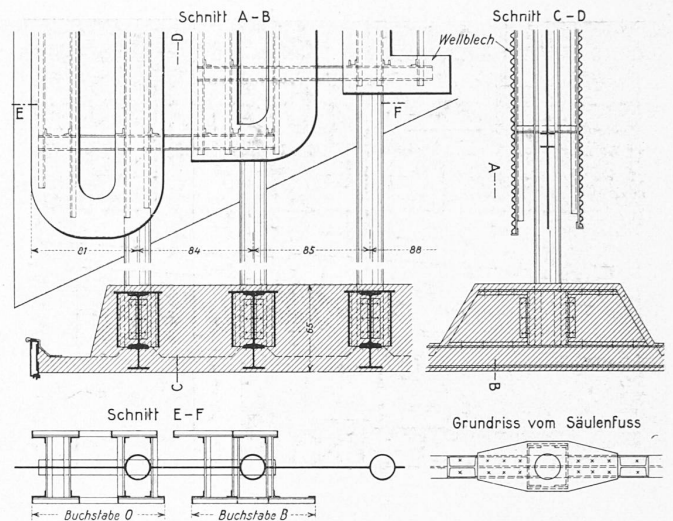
Befestigung der Reklameschrift auf dem Lichtturm. — Masstab 1:50.
